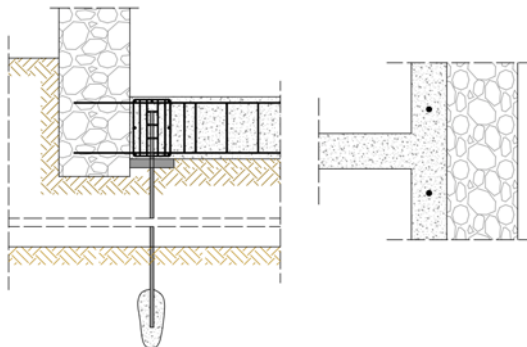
Refuerzo 2 de zapata corrida bajo muro medianero/fachada. Fuente propia.
